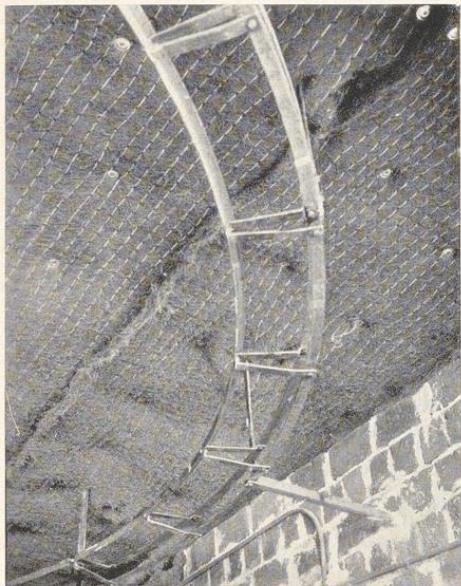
Teilbild der Formeisenkonstruktion von Bild 980 mit der hier gut sichtbaren Befestigung an Wand und Decke
